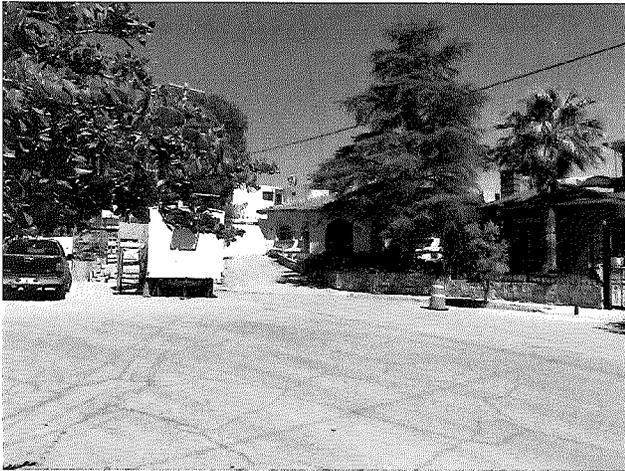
Vista del Área de Aplicación con frente a C. Presa Boquilla. ¹⁶
